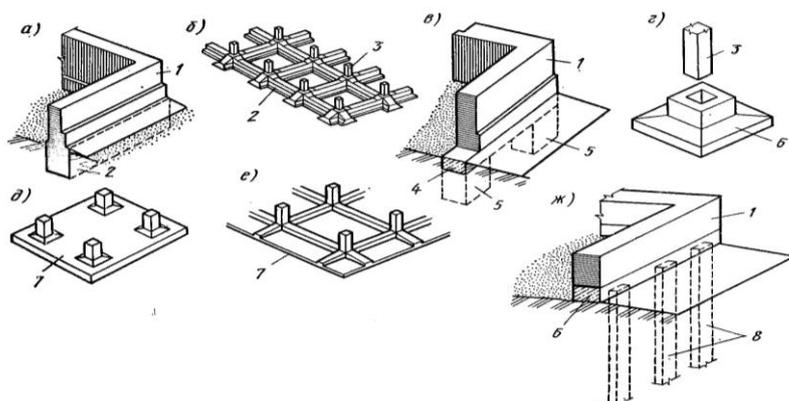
Конструктивные схемы фундаментов: а – ленточный под стены; б- то же, под колонны; в – столбчатый под стены; г – отдельный под колонну; д - сплошной безбалочный; е – сплошной балочный; ж – свайный; 1 – стена; 2 – ленточный фундамент; 3 – железобетонная колонна; 4 – железобетонная фундаментная балка; 5 – столбчатый фундамент; 6 – ростверк свайного фундамента; 7 – железобетонная фундаментная плита; 8 – сваи.
